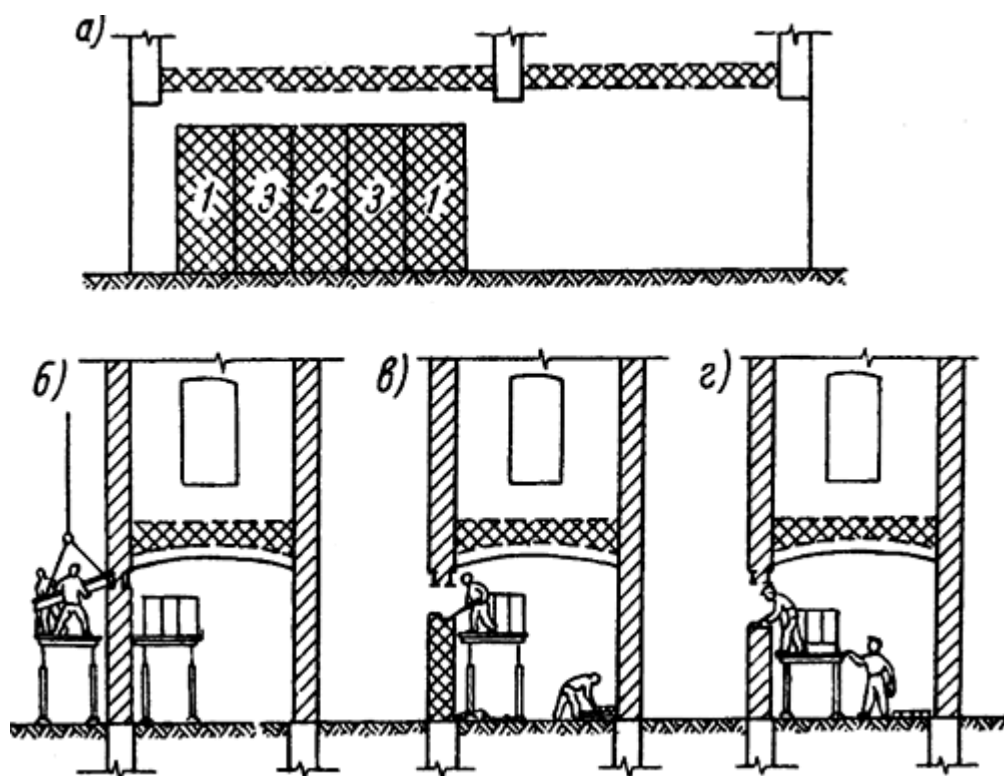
Общая схема организации работ по перекладке участка стены с сохранением вышележащей кладки
